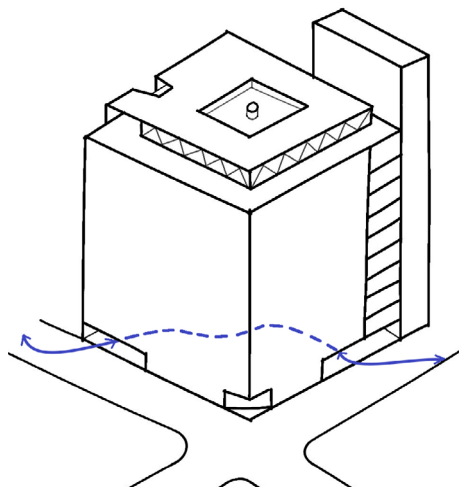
Planta baja libre por el paso de patones y sus accesos por ambas calles. (Autoría propia, 2021).
